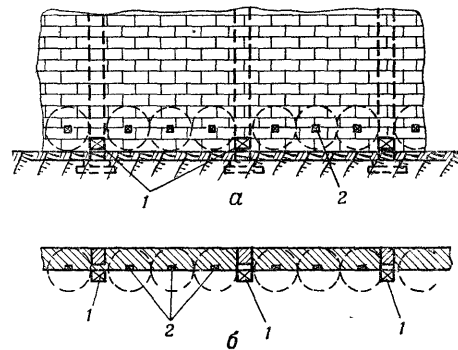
Подрывание каркасной стены сосредоточенными зарядами:
